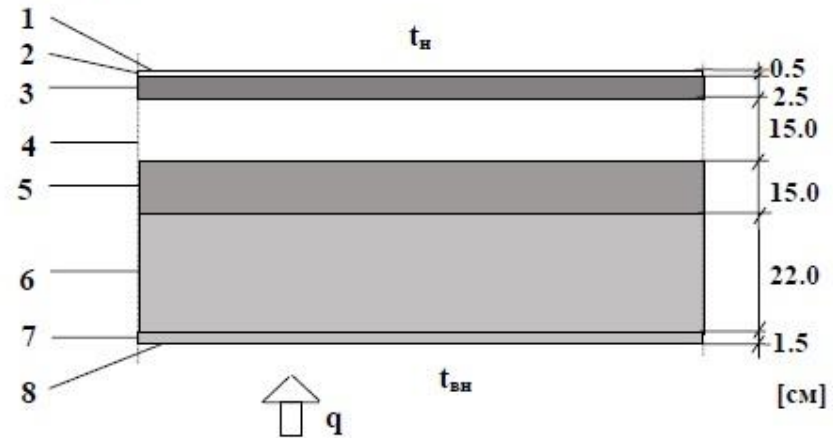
Конструкция вентилируемого чердачного перекрытия
